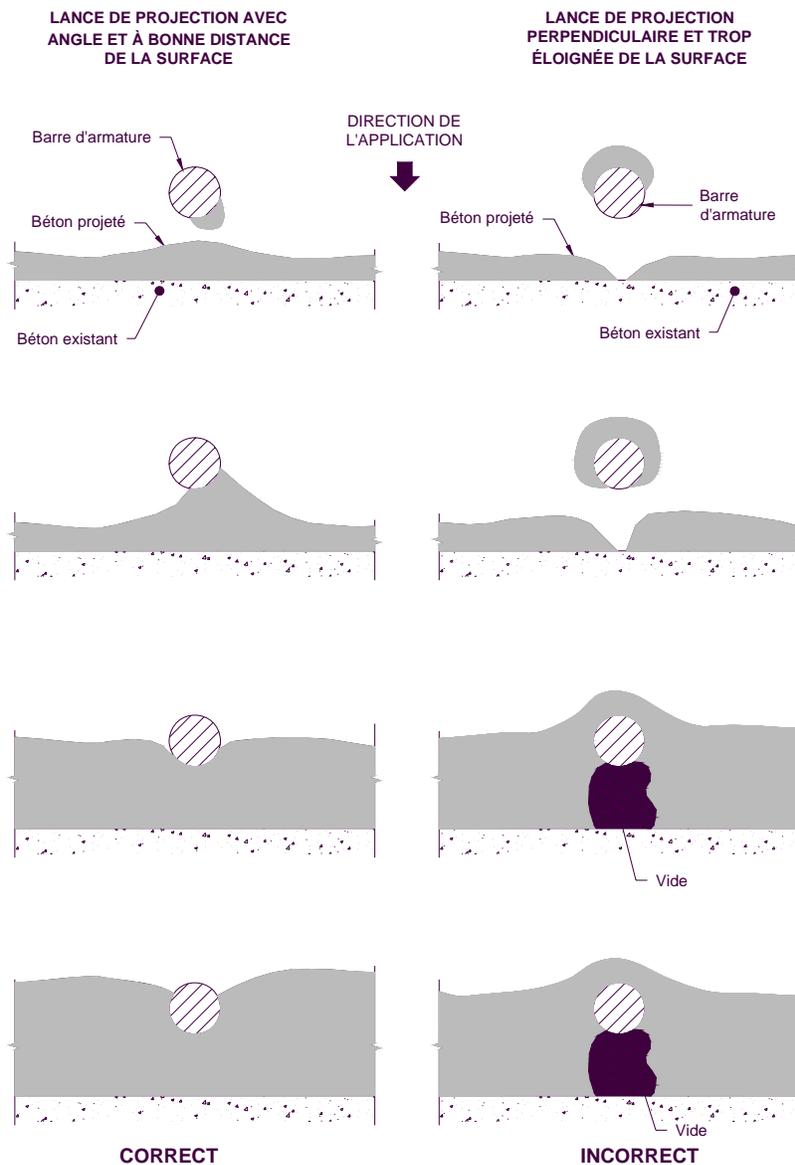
Formation d'un vide sous une barre d'armature
